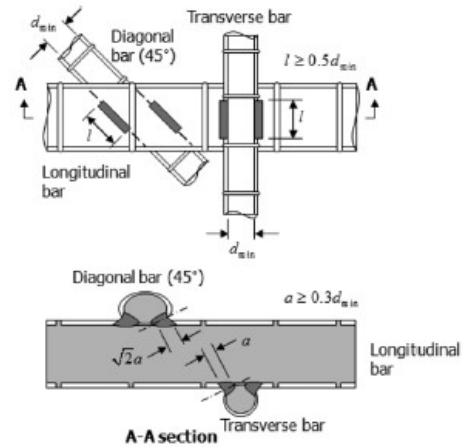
Soldadura por punto entre estribos y refuerzo longitudinal
